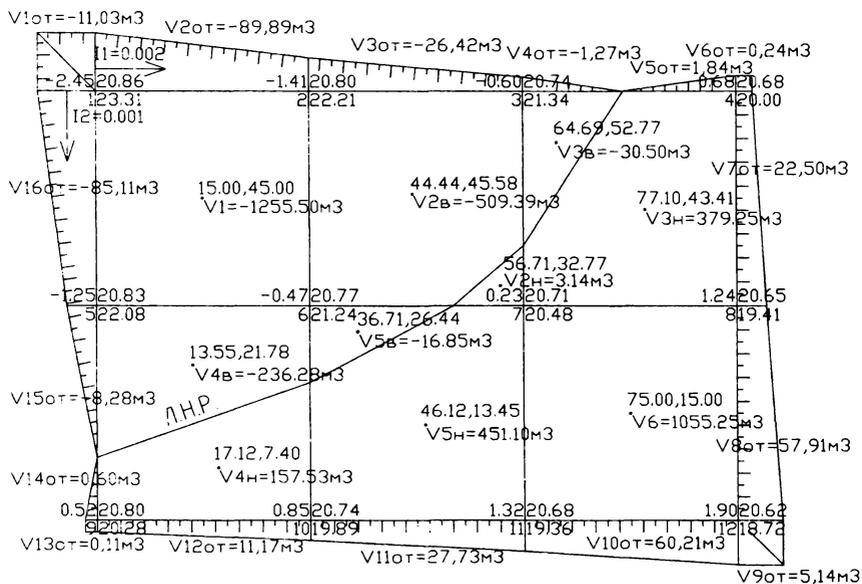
Схема площадки с объемами грунтовых масс, вычисленными способом квадратных призм
